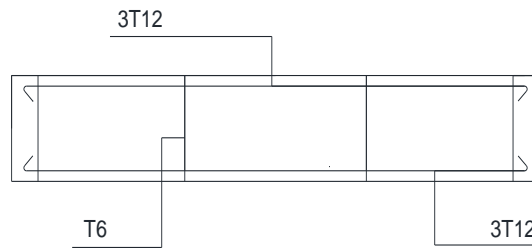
Coupe longitudinale d'une poutre noyée secondaire 15x20cm (bâtiment R+10)
